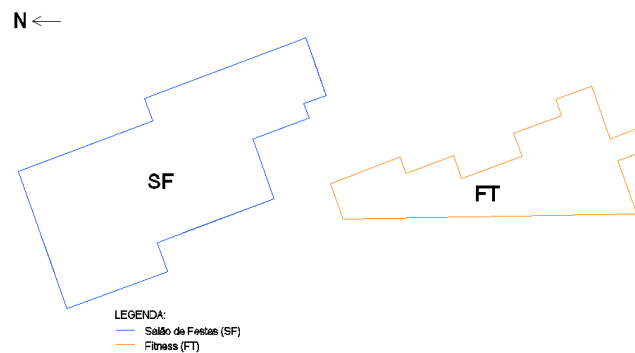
Identificação das zonas térmicas do 15º pavimento
